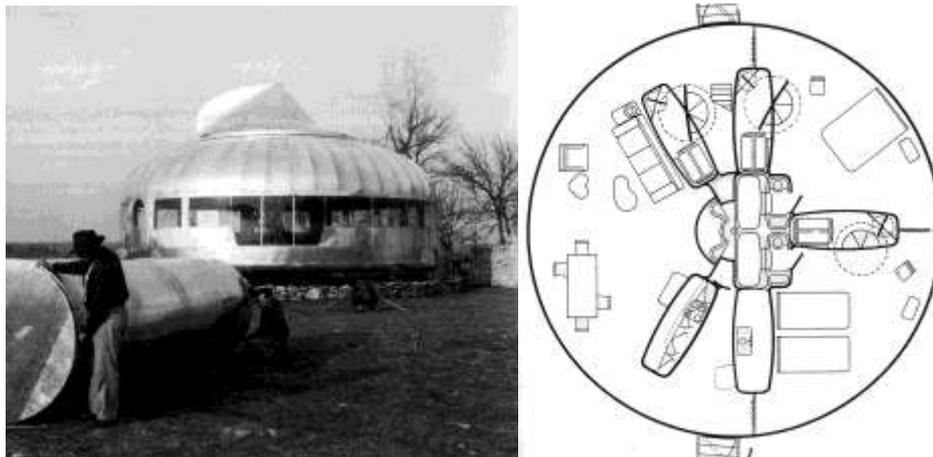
Wichita House*: a) Vista exterior; b) Planta (BALDWIN, 2010).
